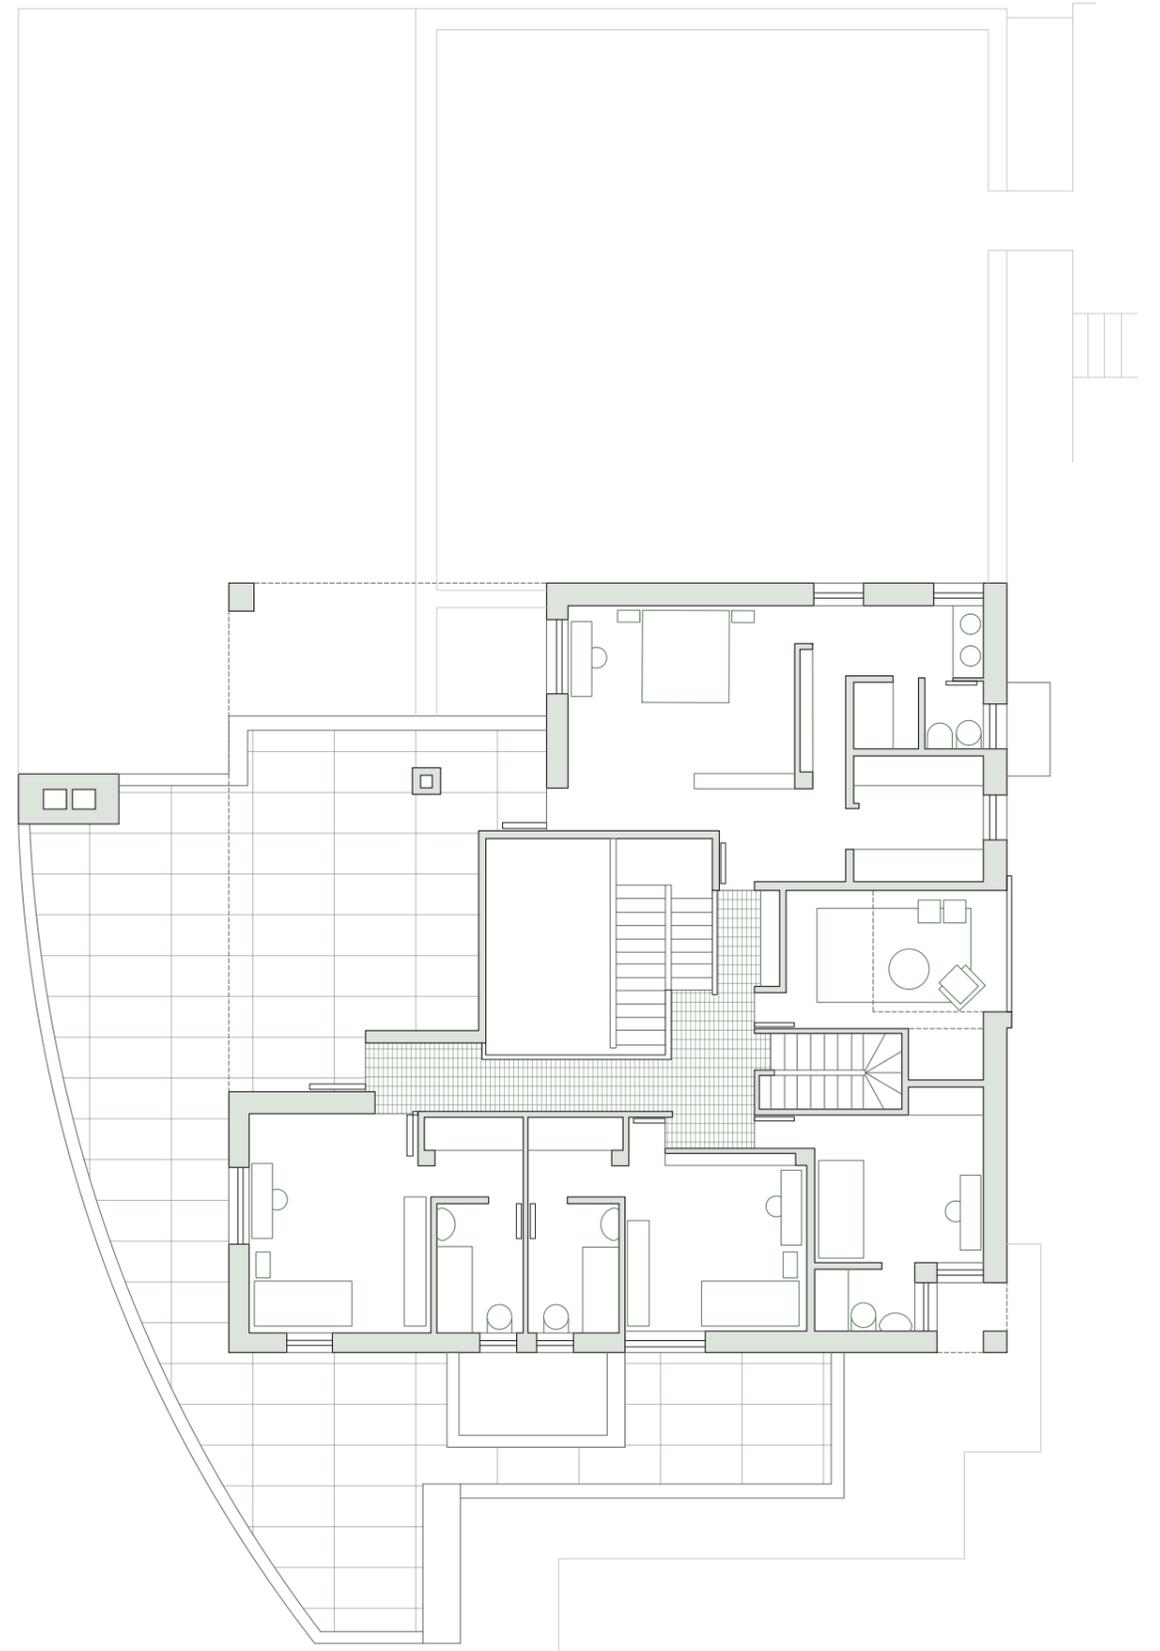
Planta primera, Casa Lirón de Robles. Escala 1:200
